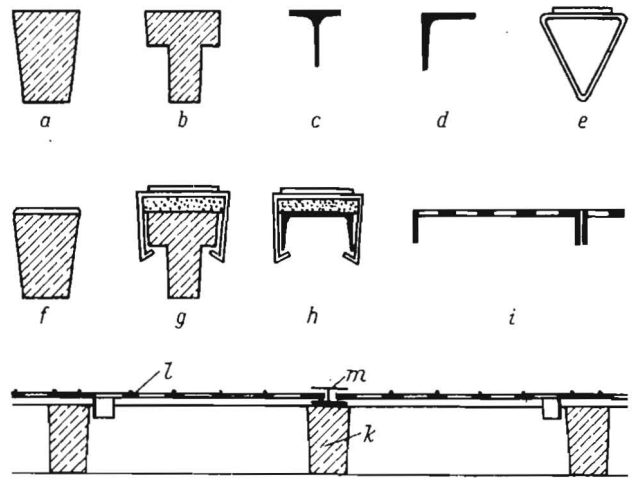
Darstellung verschiedener Spaltenbodenkonstruktionen. Bekannte Spaltenböden: a und b Stahlbeton/Keramikroste mit Trapez- bzw. T-Profil; c und d Stahlprofile; e PVC-Hohlstab; f kunststoffbeschichteter Rost; g und h Kunststoffaufstecklinge auf Stahlbeton, bzw. Stahlrosten; i ausgesteifte Lochbleche. Neuentwicklung einer perforierten Polyäthylenplatte auf Stahlbetongitterrost: k Unterkonstruktion; l Nuttschicht; m Verbindungselement
